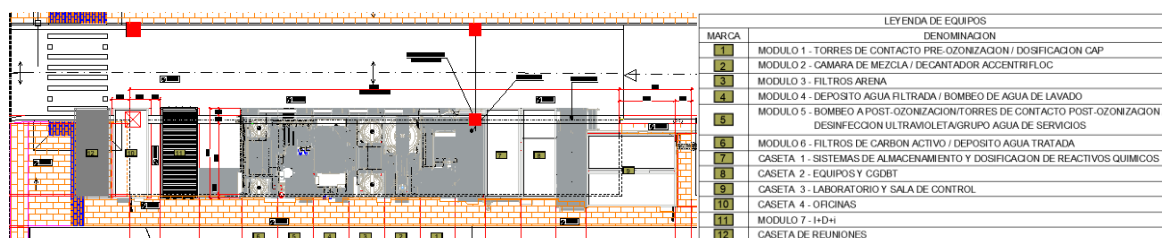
Vista en planta de los módulos y casetas de la planta piloto
